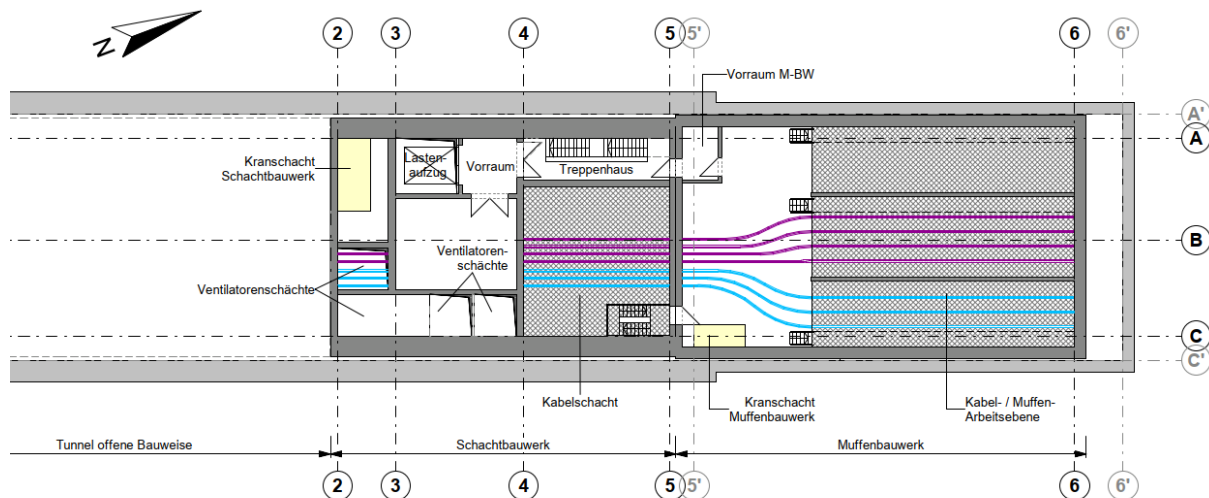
Grundriss Schachtbauwerk und Muffenbauwerk SH; 1. Untergeschoss
